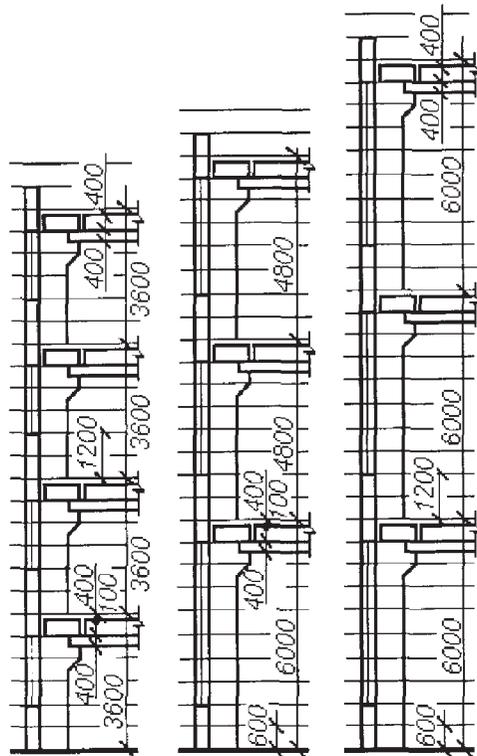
Пример раскладки панелей в стенах многоэтажных зданий
